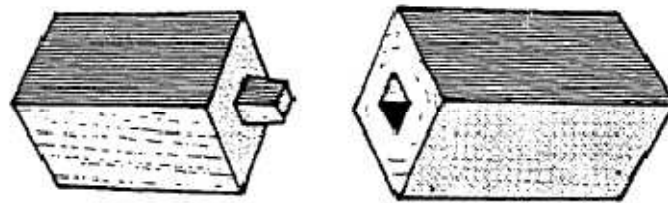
Empalme en apoyo de vigas y enlaces articulados en vanos de vigas de gran escuadría (fuente: Cismadeira)
